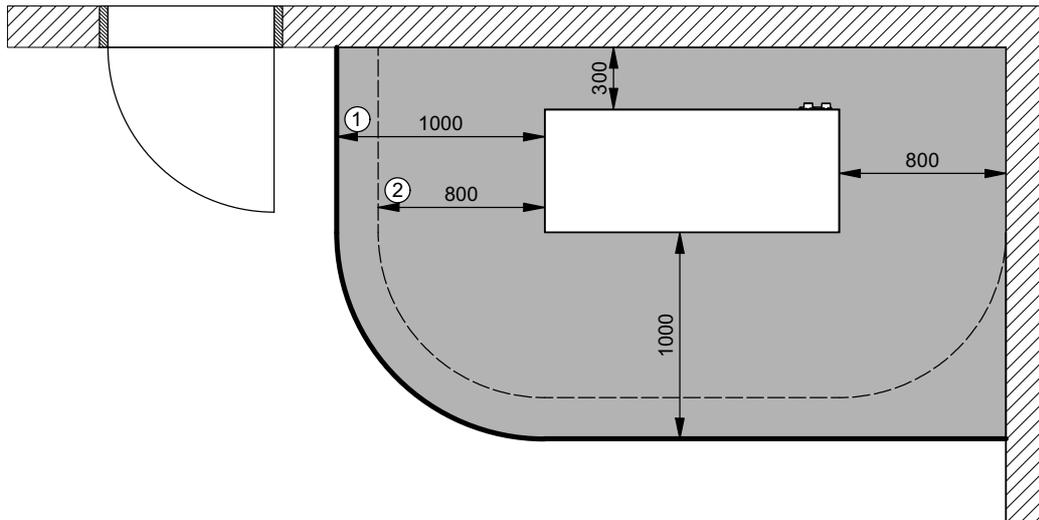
Zona sicura (installazione sopraelevata) in caso di installazione ad angolo
